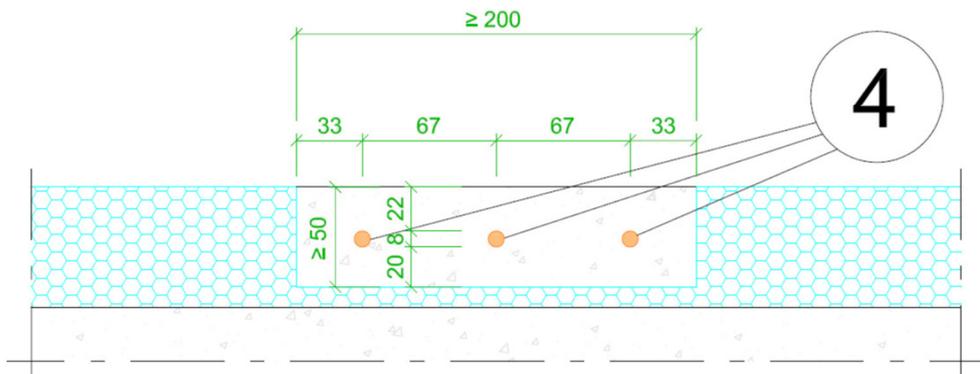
Vue de coupe – Conditions géométriques longitudinales et ferrailage
